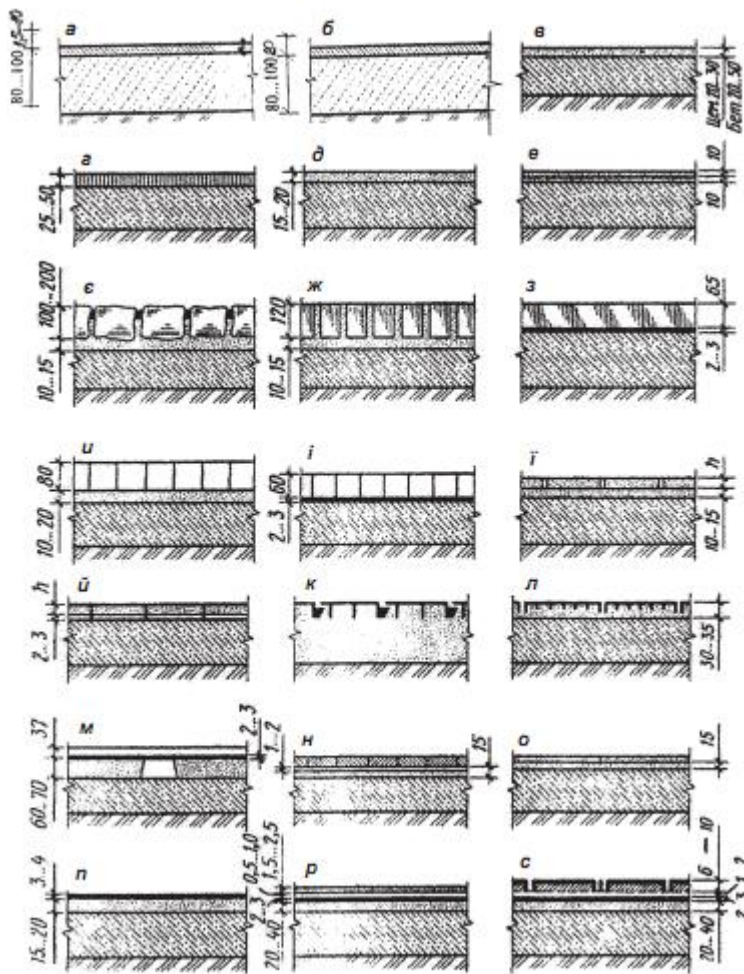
Конструктивні рішення підлоги виробничих будівель: а – полімерна наливна; б – полімерцементна; в – бетонна; г – асфальтобетонна; д, е – ксилолітова; е – брущата; з – цегляна; и, і – торцева; й – плиткова; к, л – металева; м – дощата; н – паркетна; о – із лінолеуму; п – полівінілацетатна; р – з полівінілхлоридного лінолеуму; с – із фенолітових плиток
